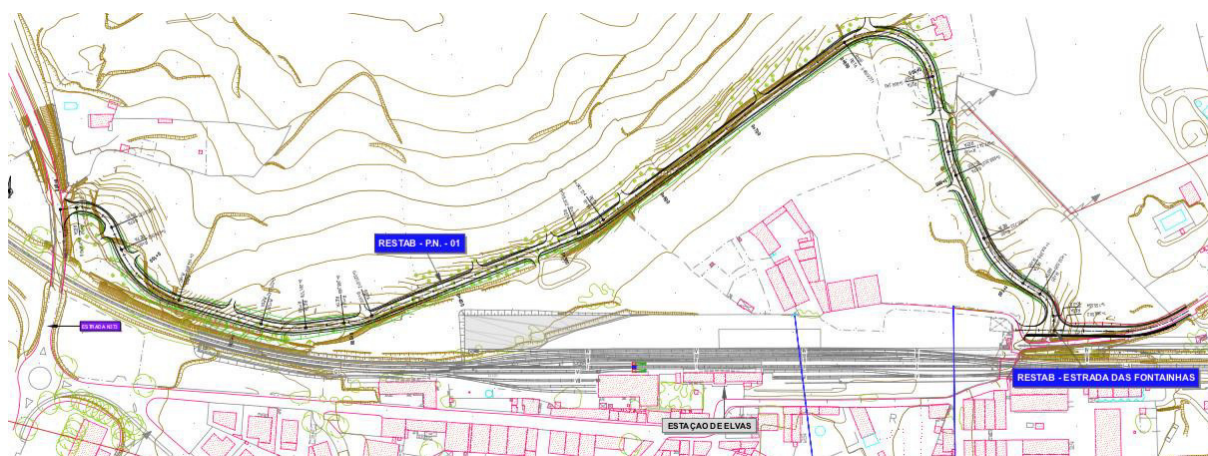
Planta de Traçado - Restabelecimento PN 1
